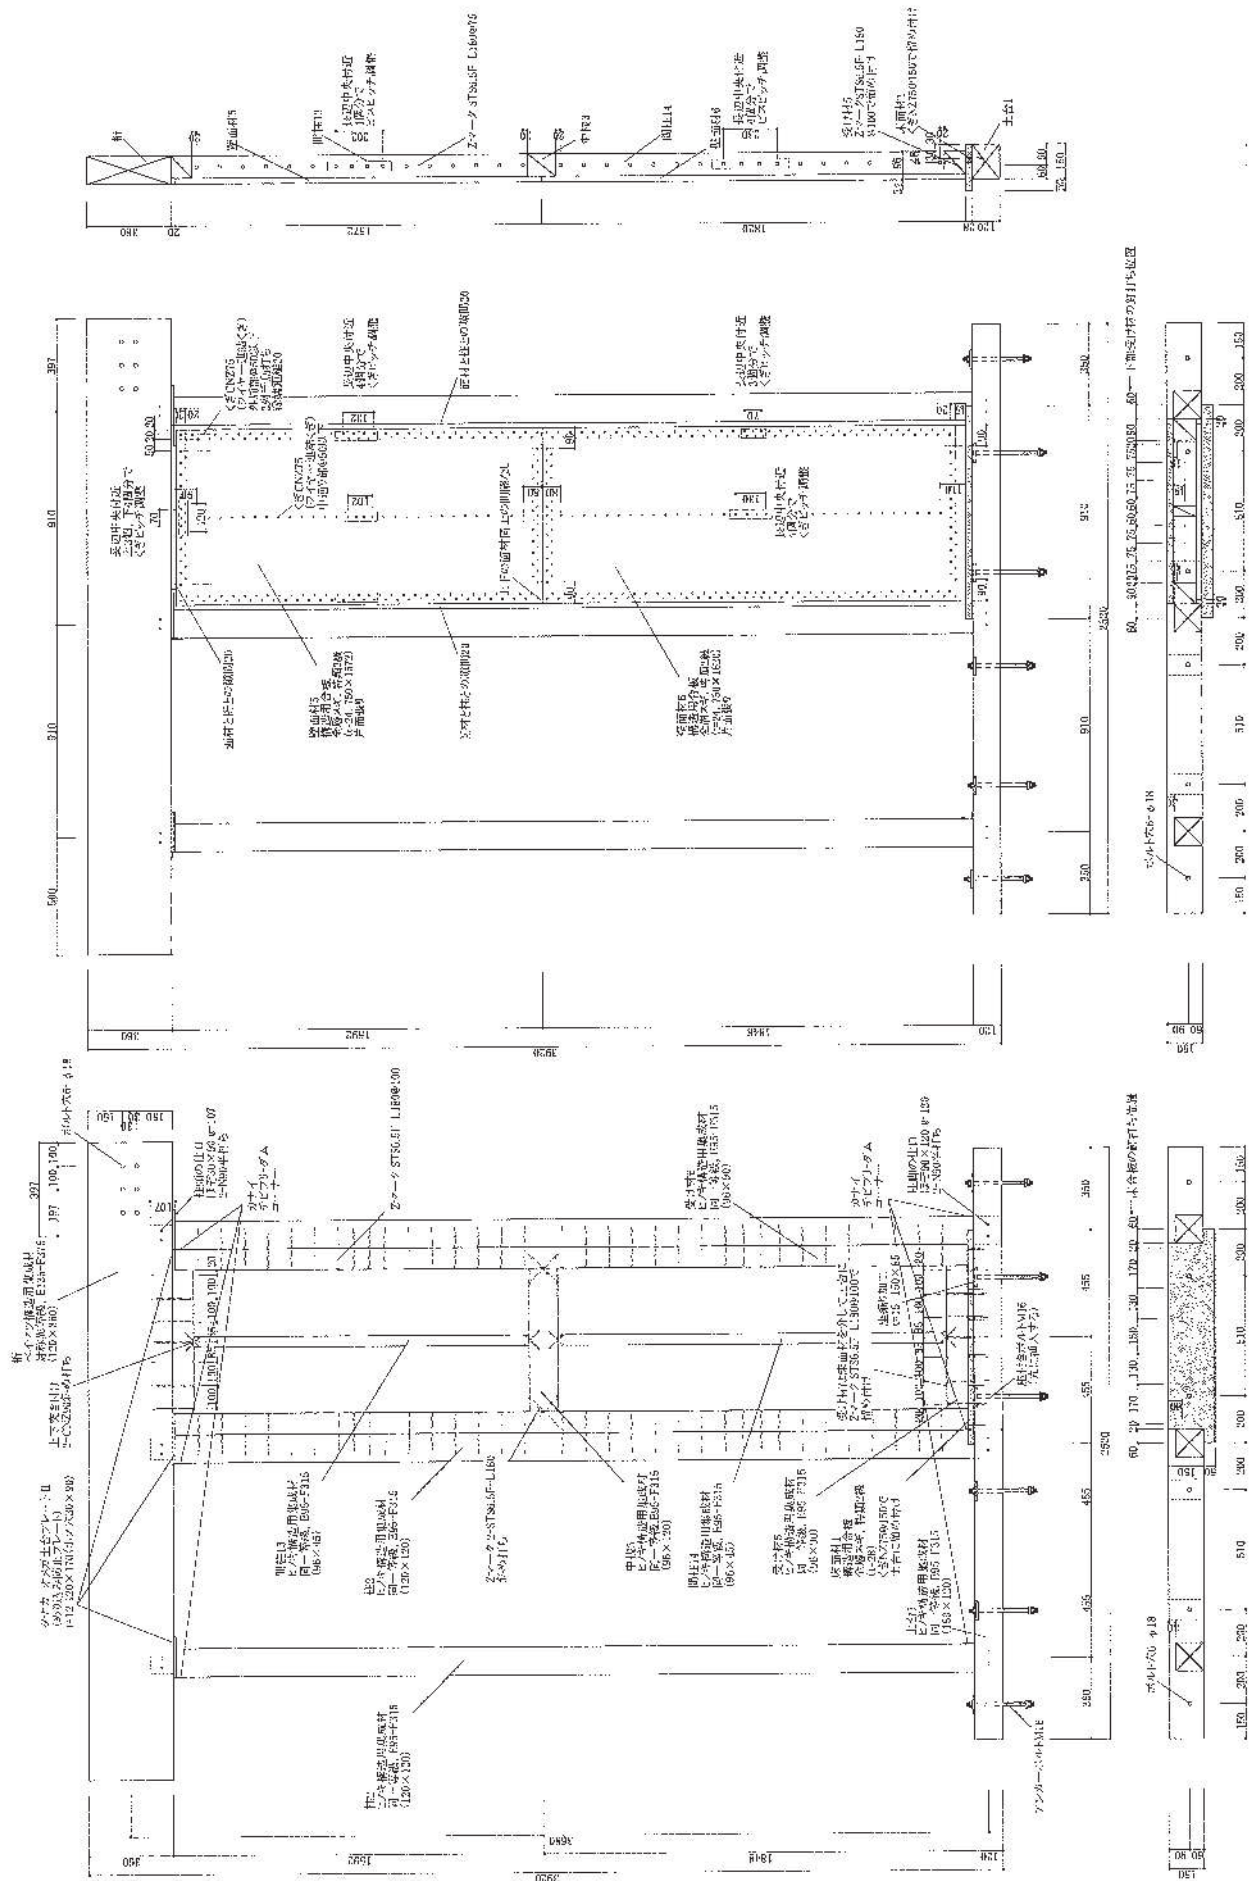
10: No. 10-I 試験体の詳細図 (mm)
